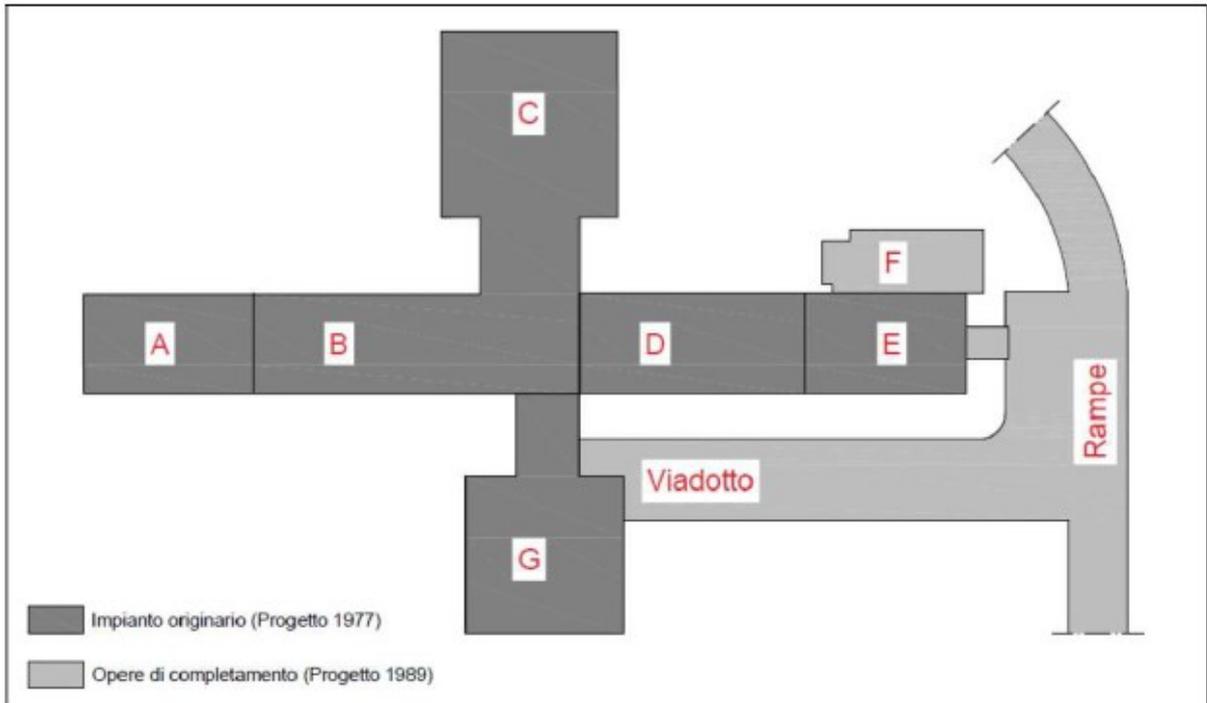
Schema planimetrico del Padiglione A alla fine degli anni '80
